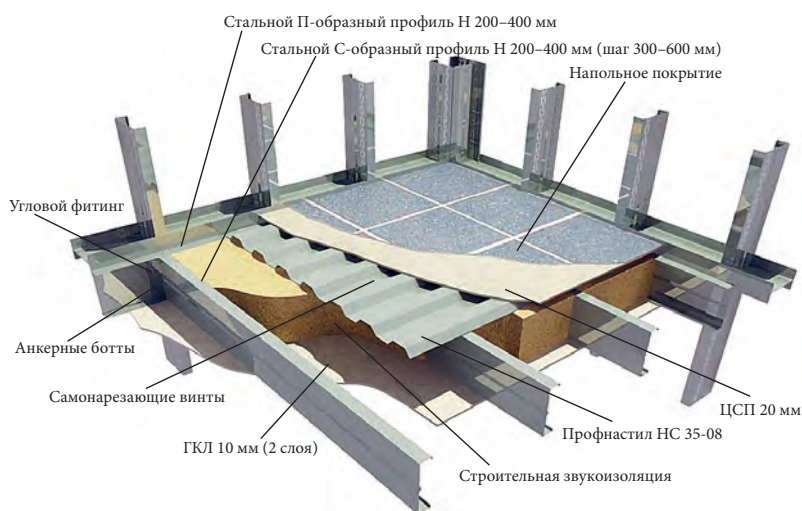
Общий вид перекрытия из профилированного настила
